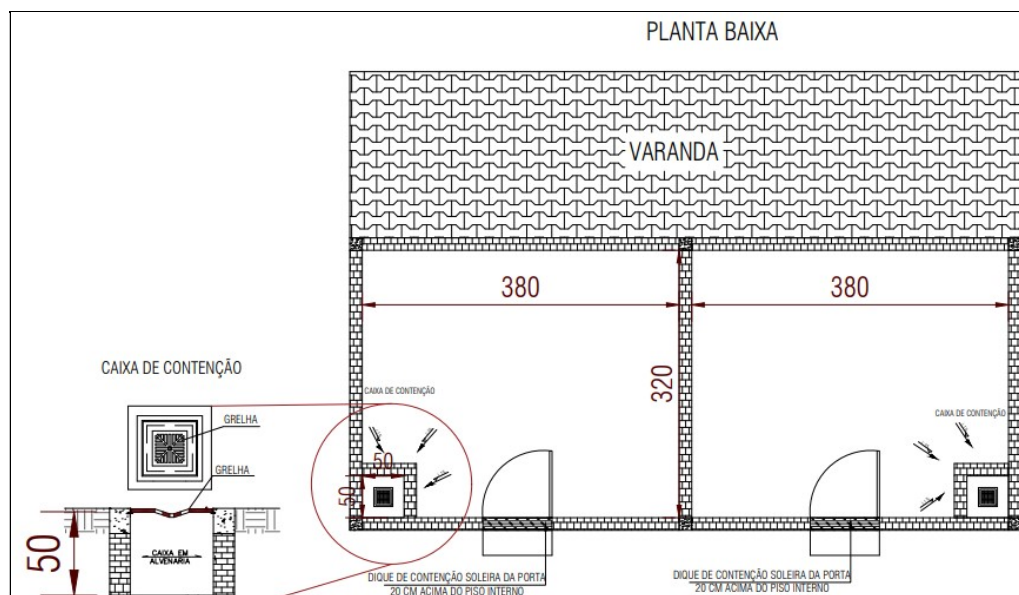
Estrutura para armazenamento de embalagens contaminadas com óleo lubrificante.
